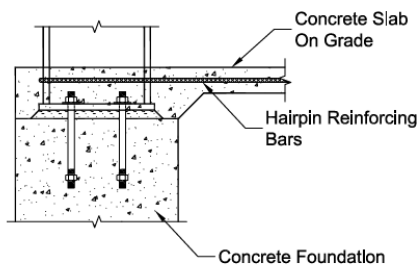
Detallado alternativo de barras de horquillas. Tomado de *Design Guide No. 1: Base Plate and Anchor Rod Design (p.1)*, por American Institute of Steel Construction, 2006. Copyright 2006 por AISC.
